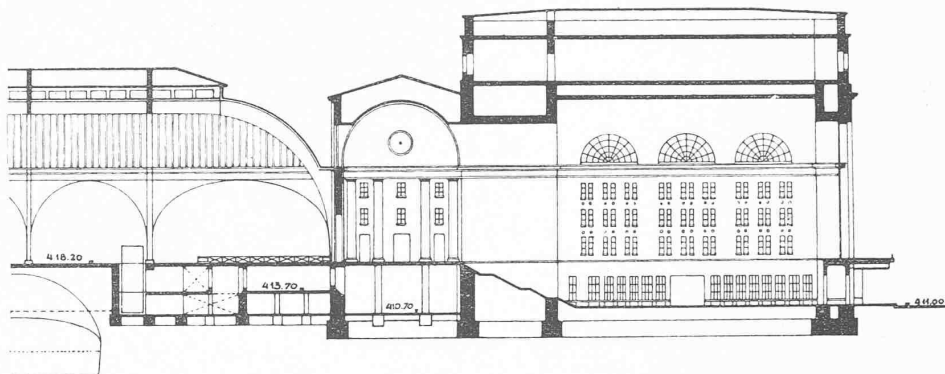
Schnitt in Geleiserichtung durch Kopfperron- und Eingangs- (Schalter-) Halle. — Masstab 1:1000.
